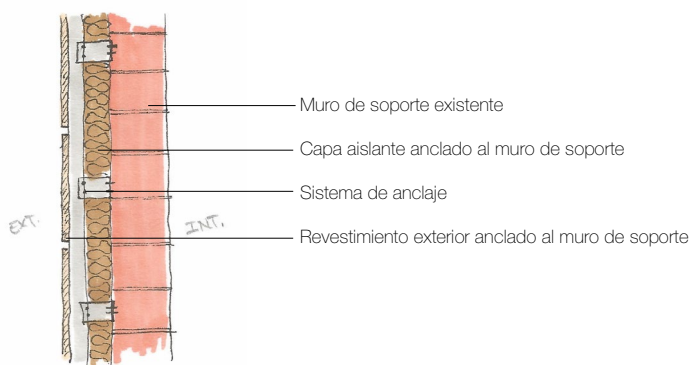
Detalle genérico en sección de fachada ventilada (autoría propia).
